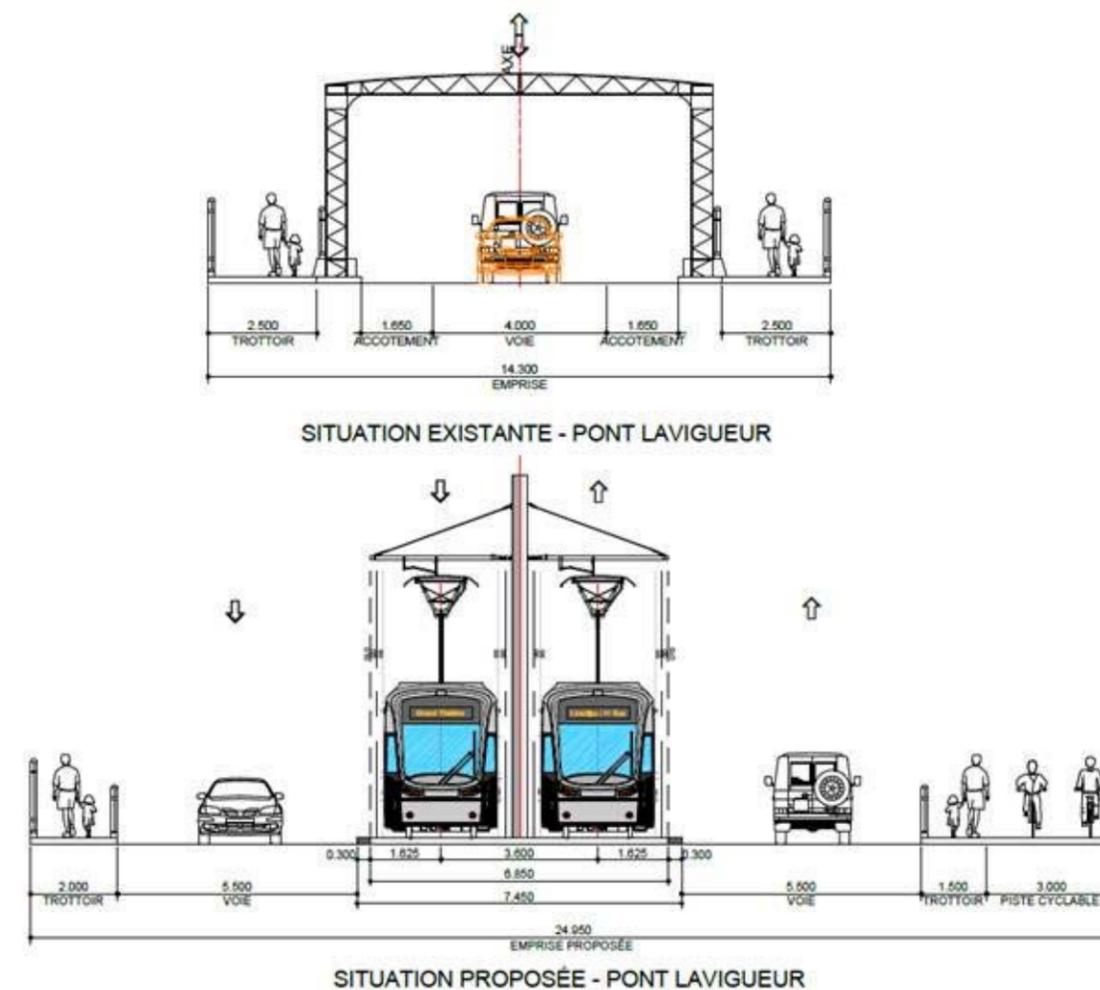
Coupes types des situations existante et proposée pour le pont Lavigueur
